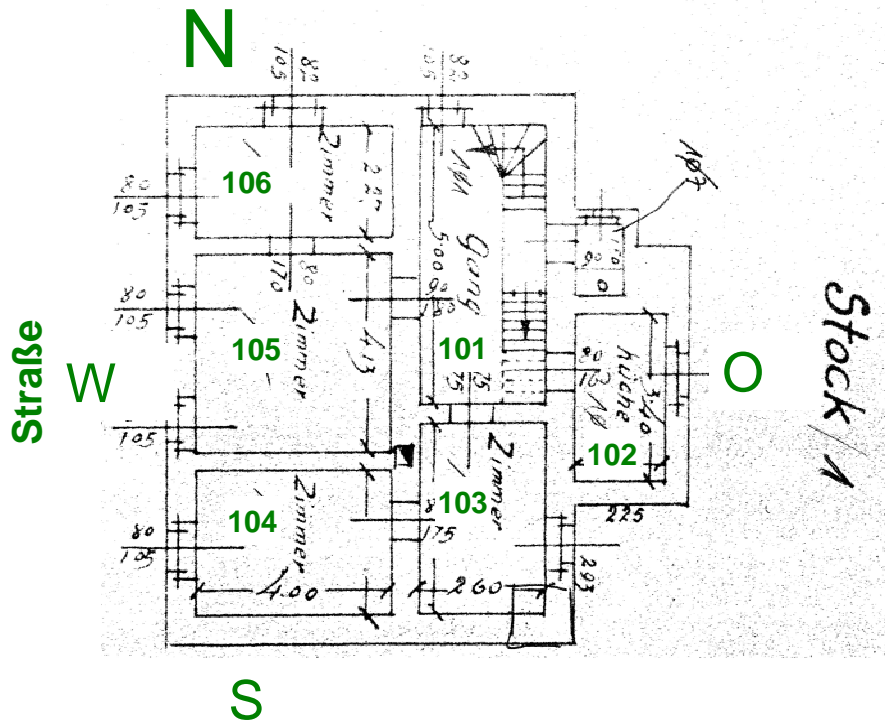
Grundriss mit Raumnummern, 1. Stock
